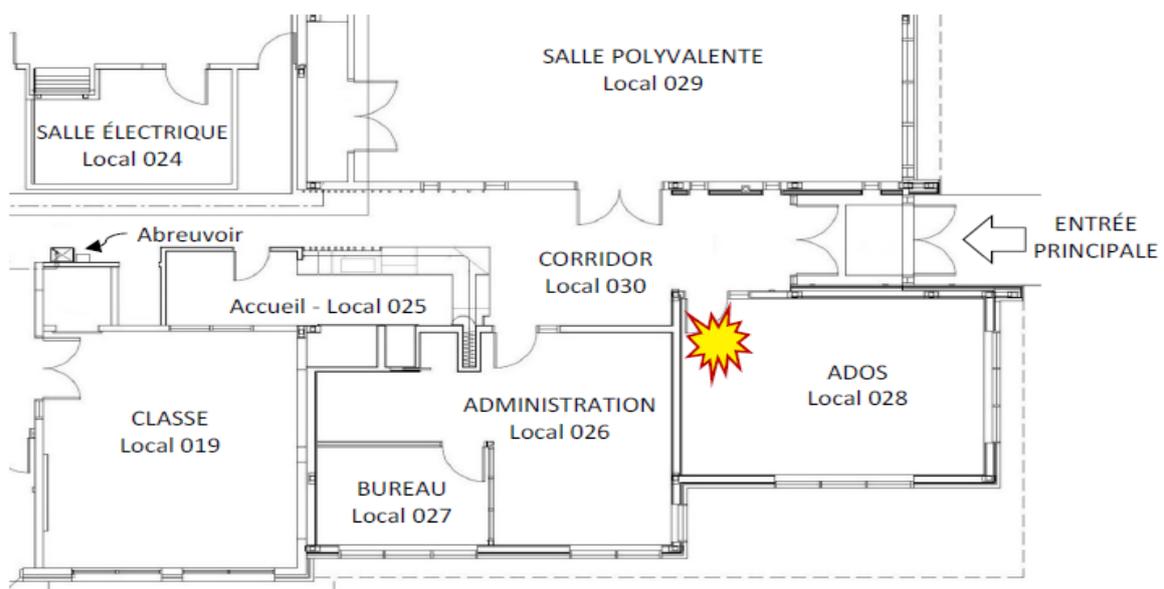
Lieu de l'accident sur un extrait du plan du Pavillon de la Savane
